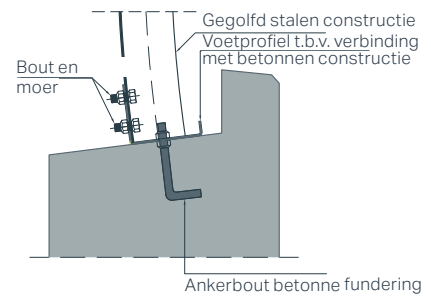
Aansluiting van de staalconstructie op betonnen funderingen
